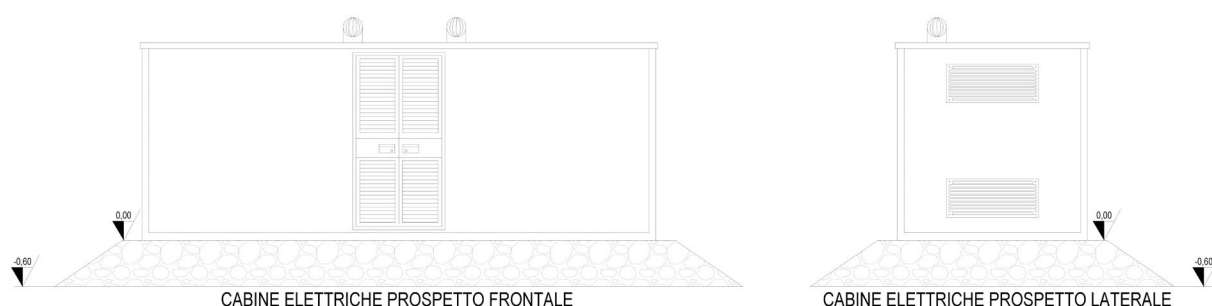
Posa Sopraelevata delle Cabine di Consegna
